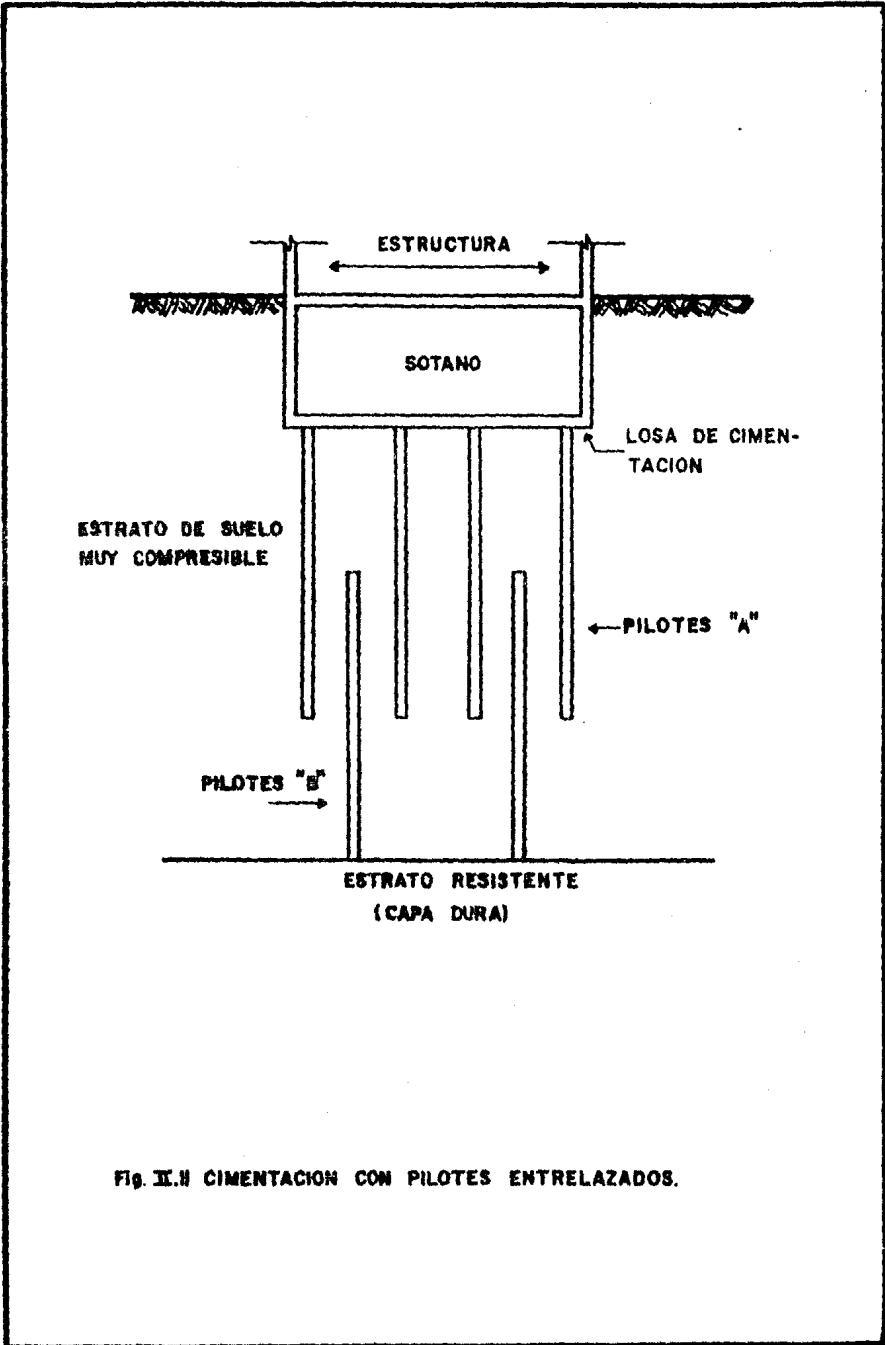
CIMENTACION CON PILOTES ENTRELAZADOS.
